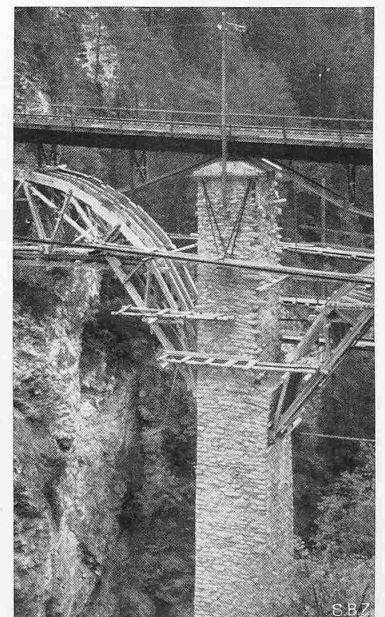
Aufgemauerter Pfeiler 2 vor Abbruch des Lehrgerüsts
